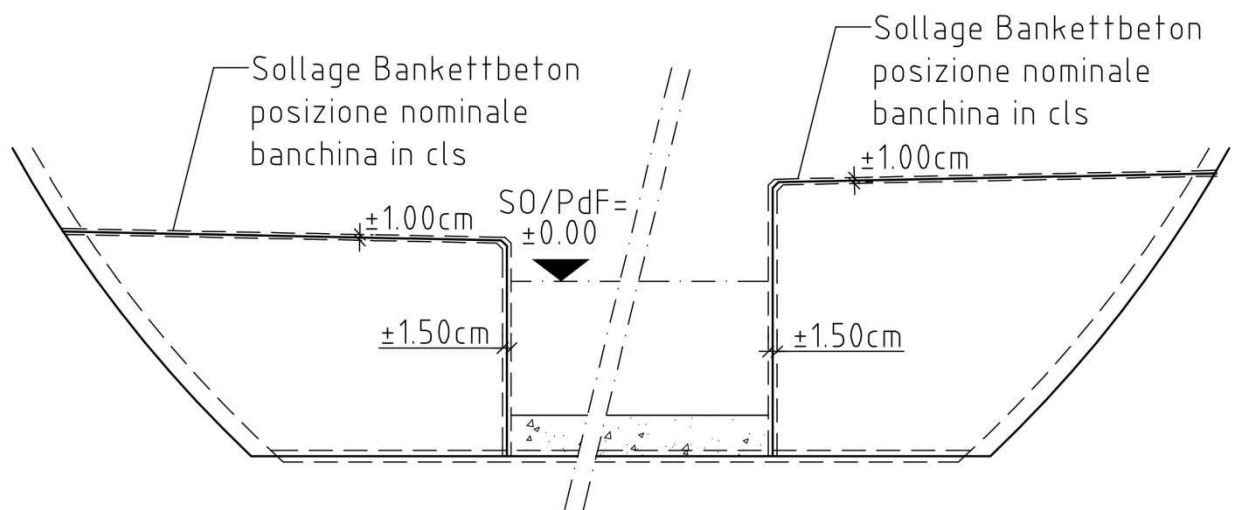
Toleranzen Haupttunnel - Bankett (Bankett aus Beton)
